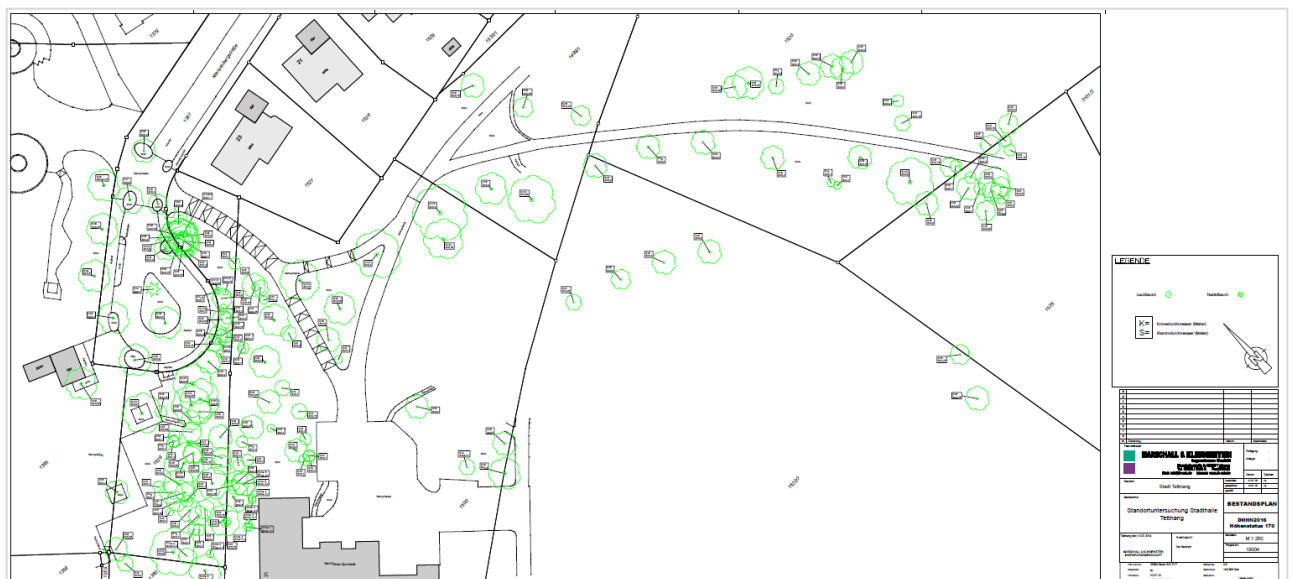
Baumbestand im Bereich der geplanten Sporthalle Manzenberg, Tettang. Plan von Marschall & Klingenstein Ing. GmbH, Tettang, vom 01.07.20219.
